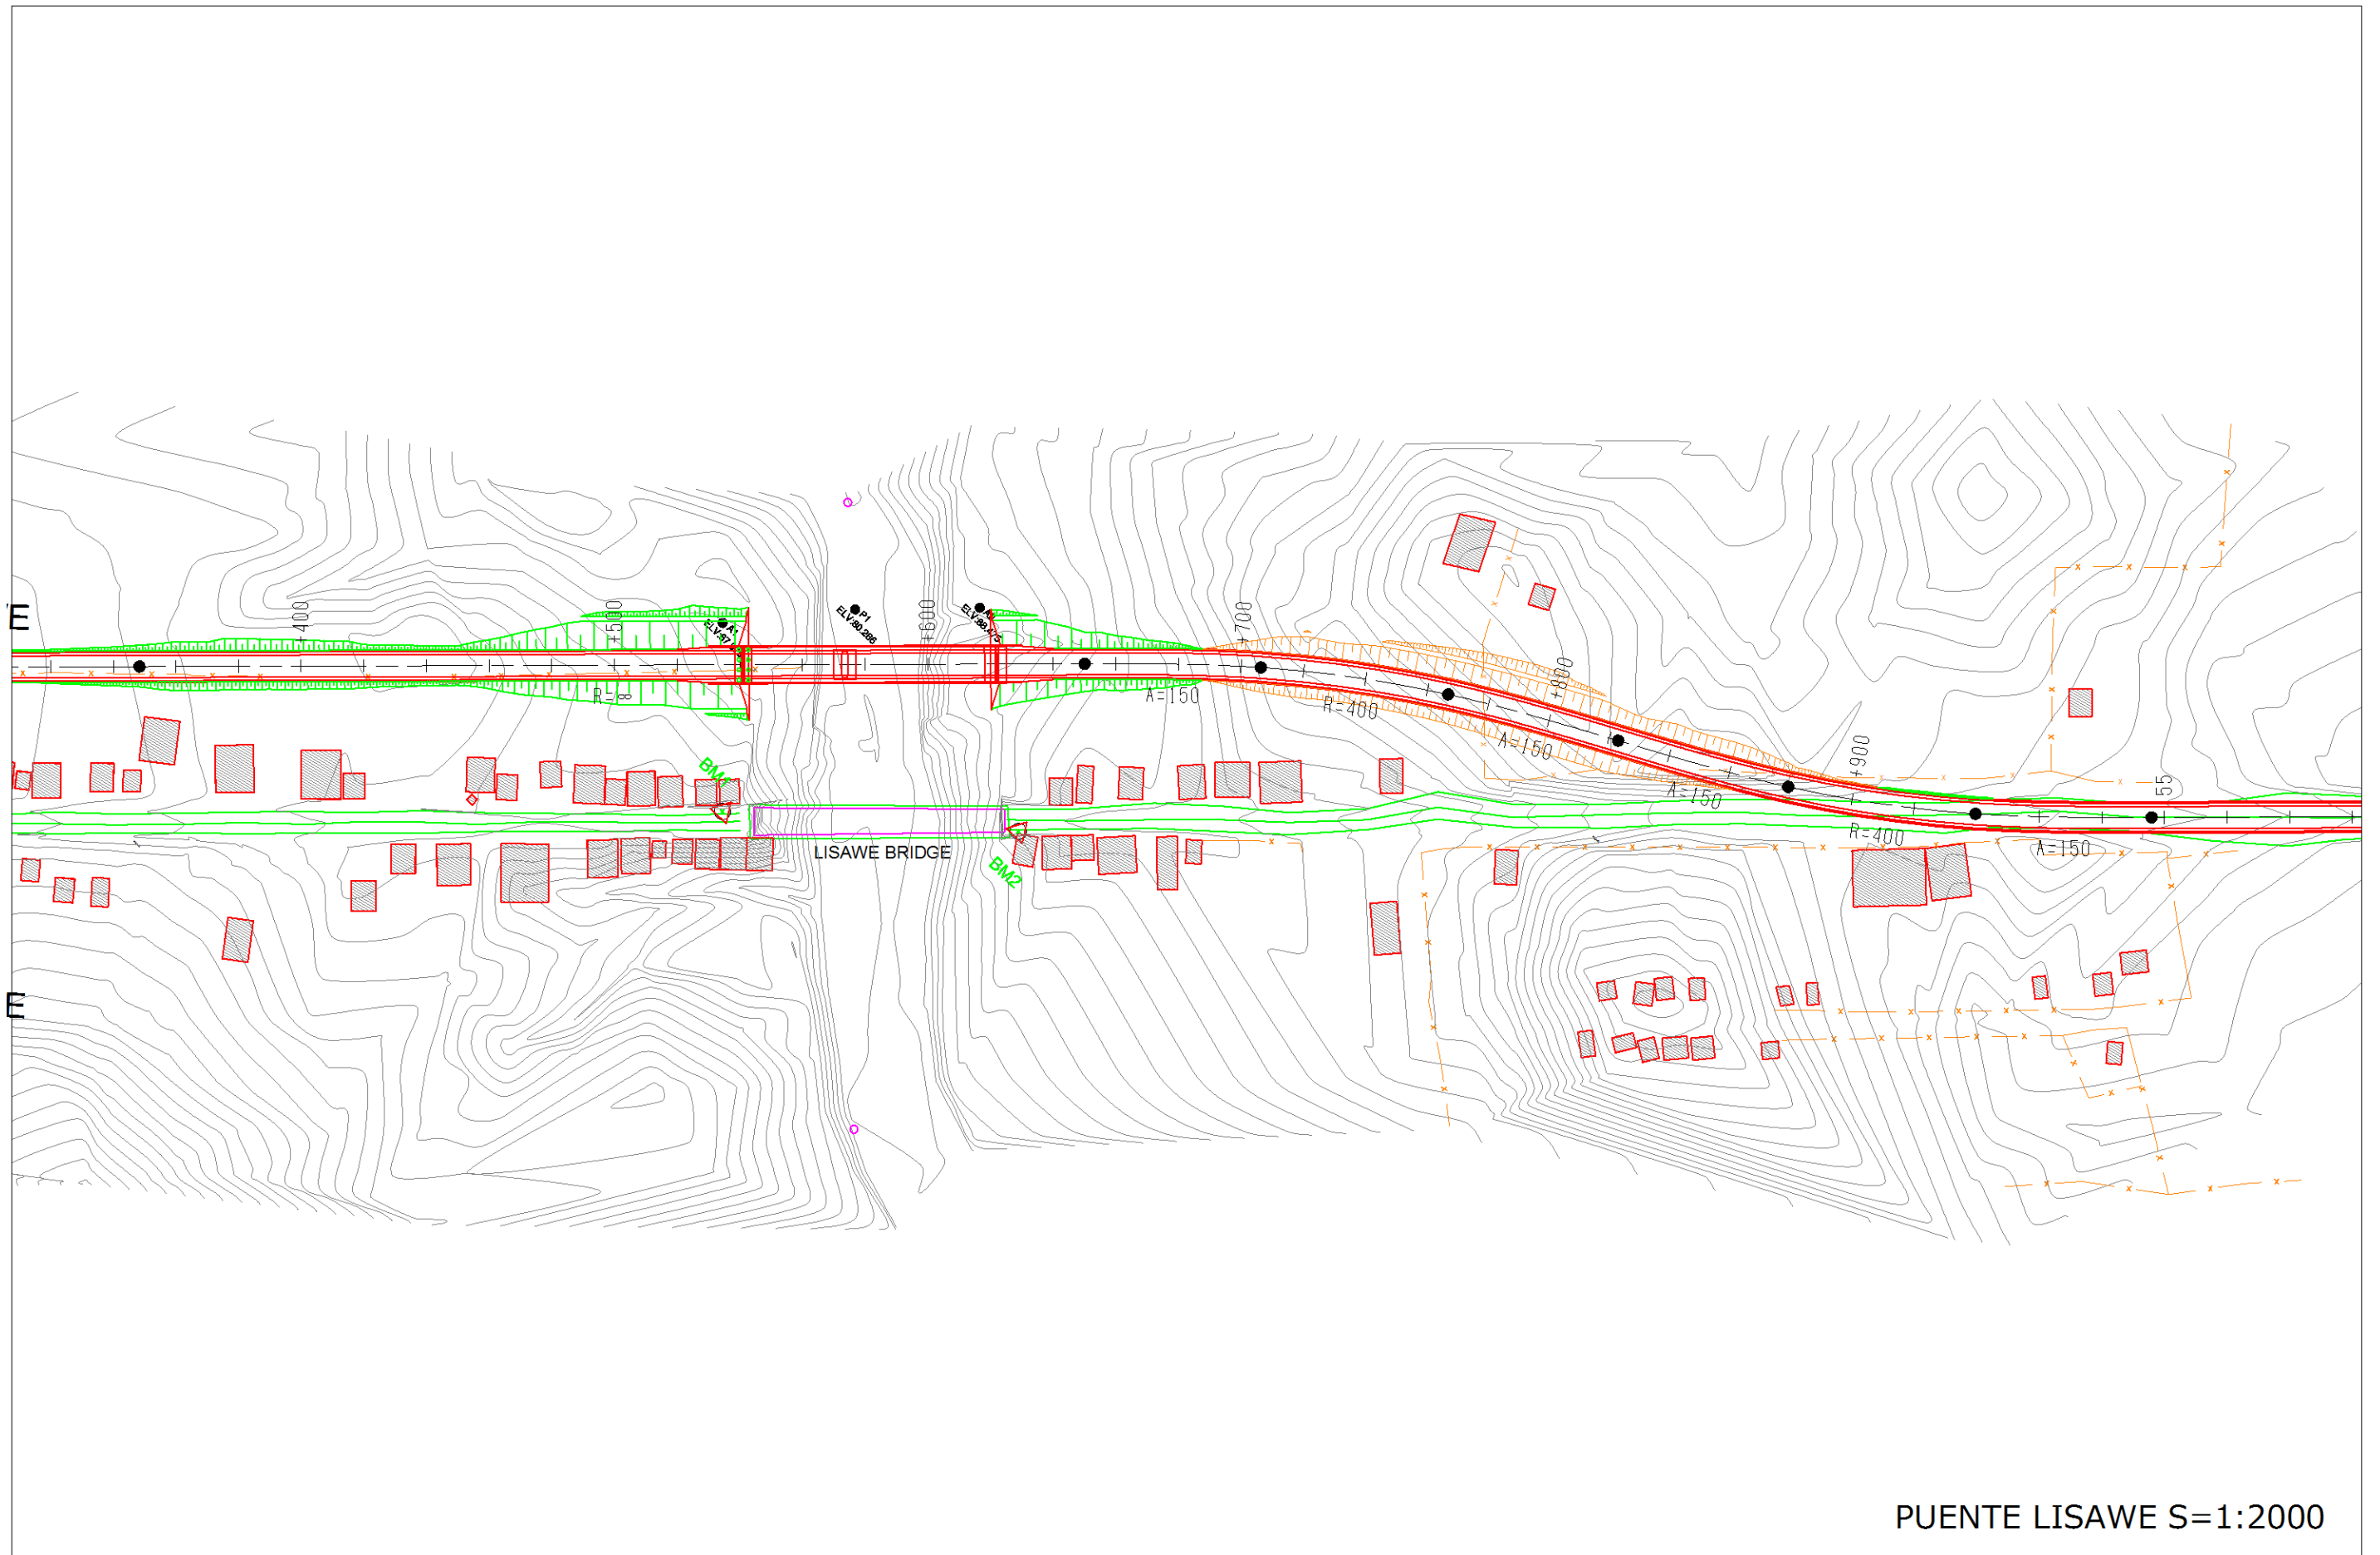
Plano en planta de la nueva ubicación del puente (Puente Lisawe (2/2))
